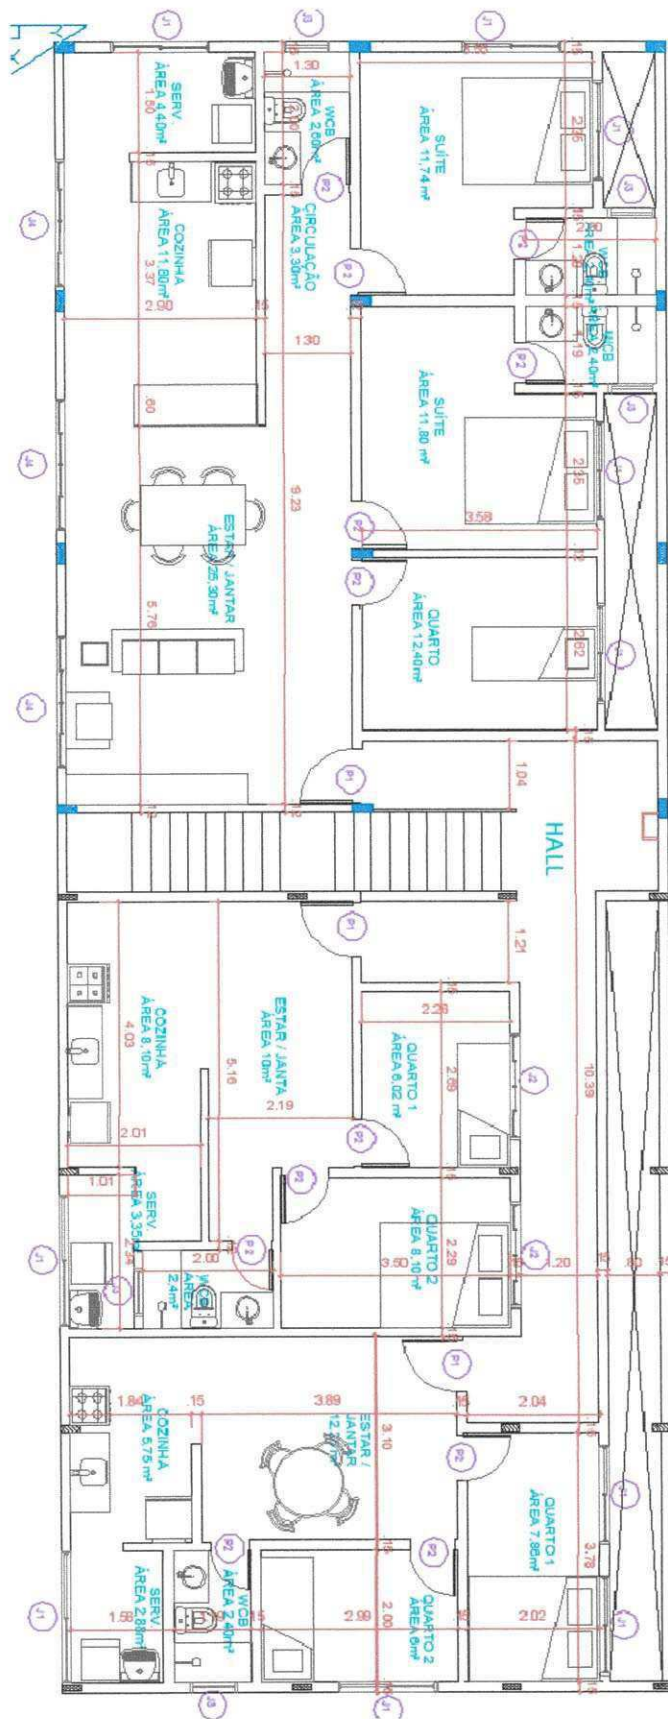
Planta baixa pavimento superior edificação Banabeiras-PB
